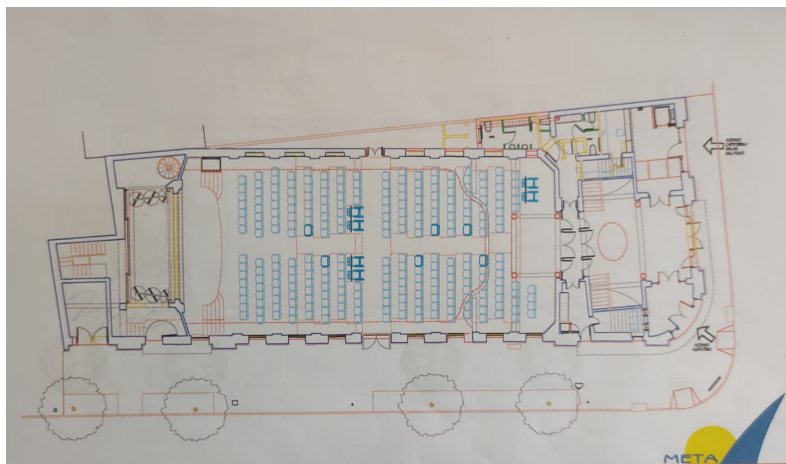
Planta-baixa do pavimento térreo da sala C1980 [3].
